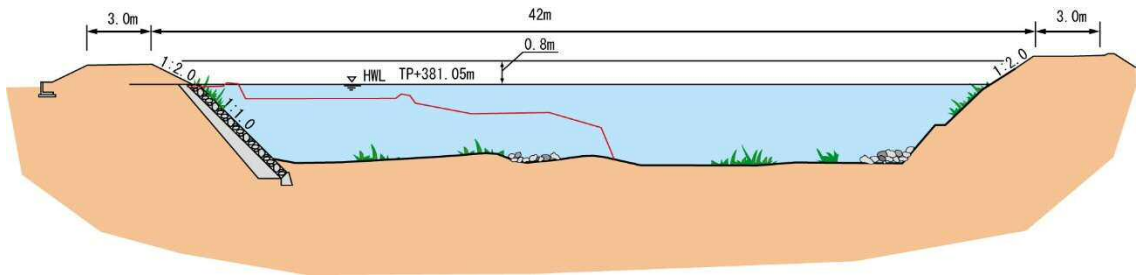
横断面图 (新庄工区, 脇原橋付近)
